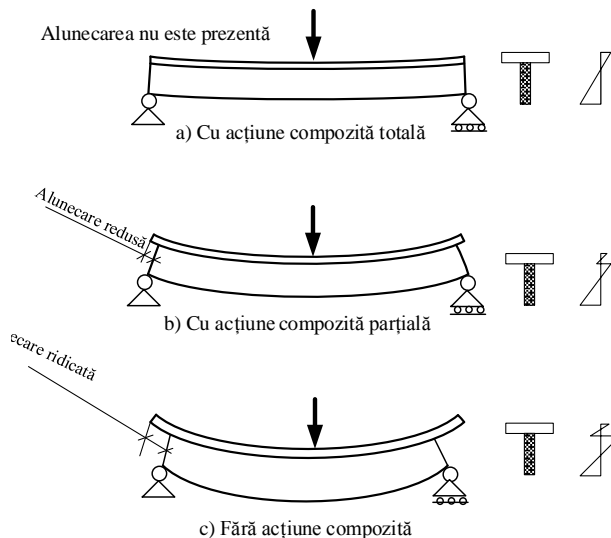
Tipuri de acțiuni în elemente lemn-beton
